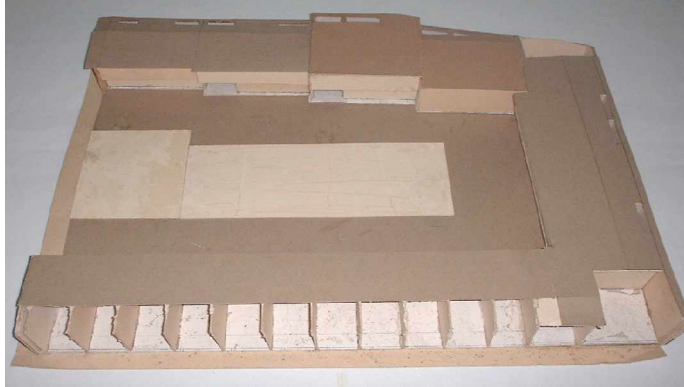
PLANTA COMPLETA VISTA LADO DERECHO
